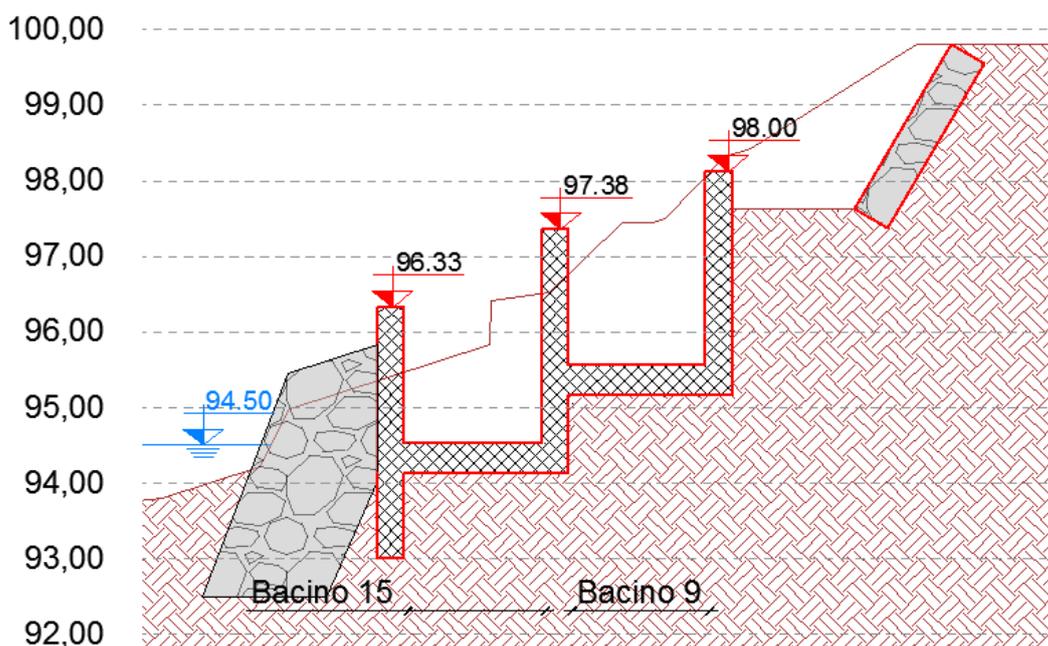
Vista della sezione E-E, estratto della tavola D.1.2.
